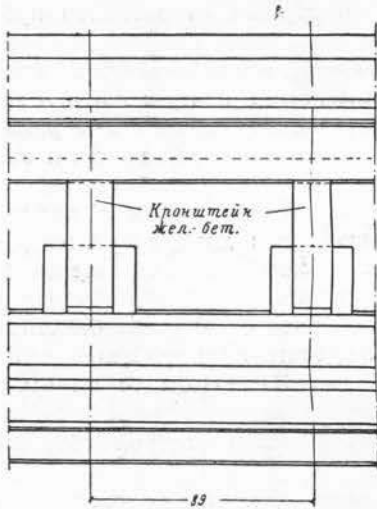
Схема фасада без архитектурных деталей железобетонных кронштейнов
